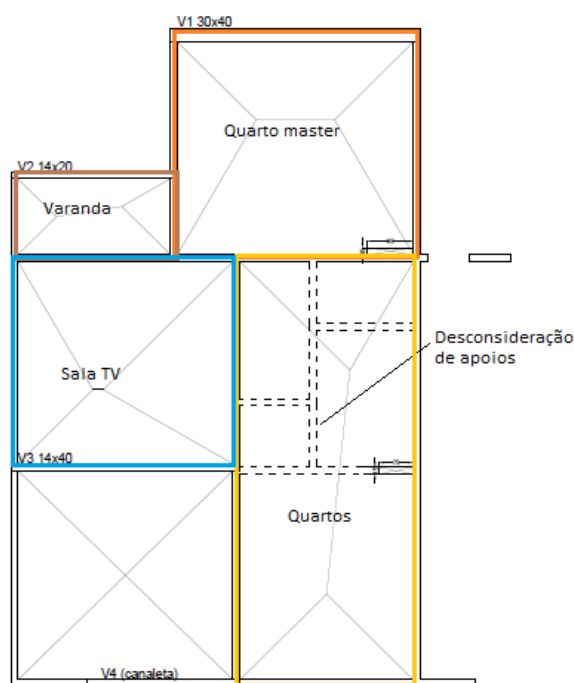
Modelagem de apoios das lajes do primeiro pavimento, análogo à cobertura
